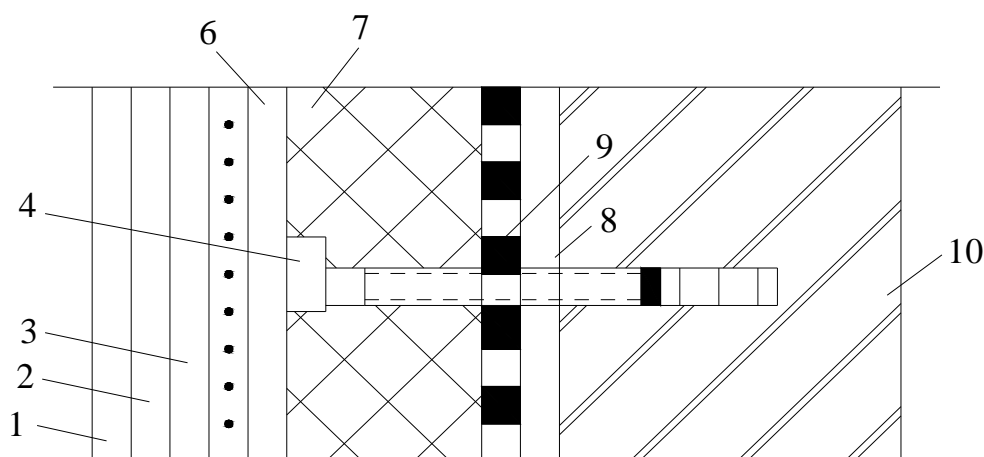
Закрепление скрепленной теплоизоляции (схема):
